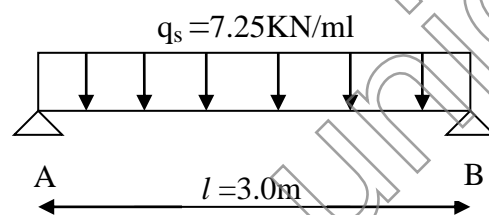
schéma statique de la poutre de chaînage à l'ELS.
